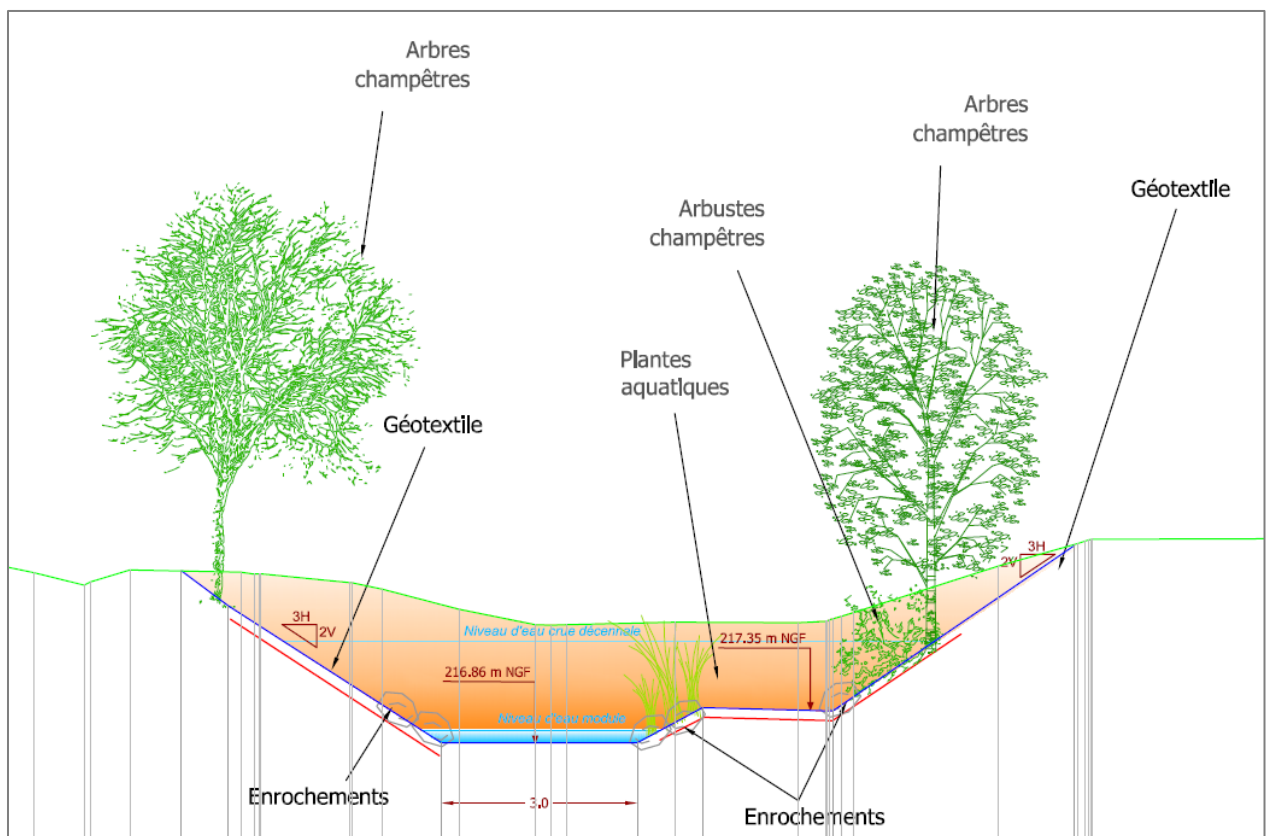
Profil en travers type de la zone de restauration du lit du Garon
